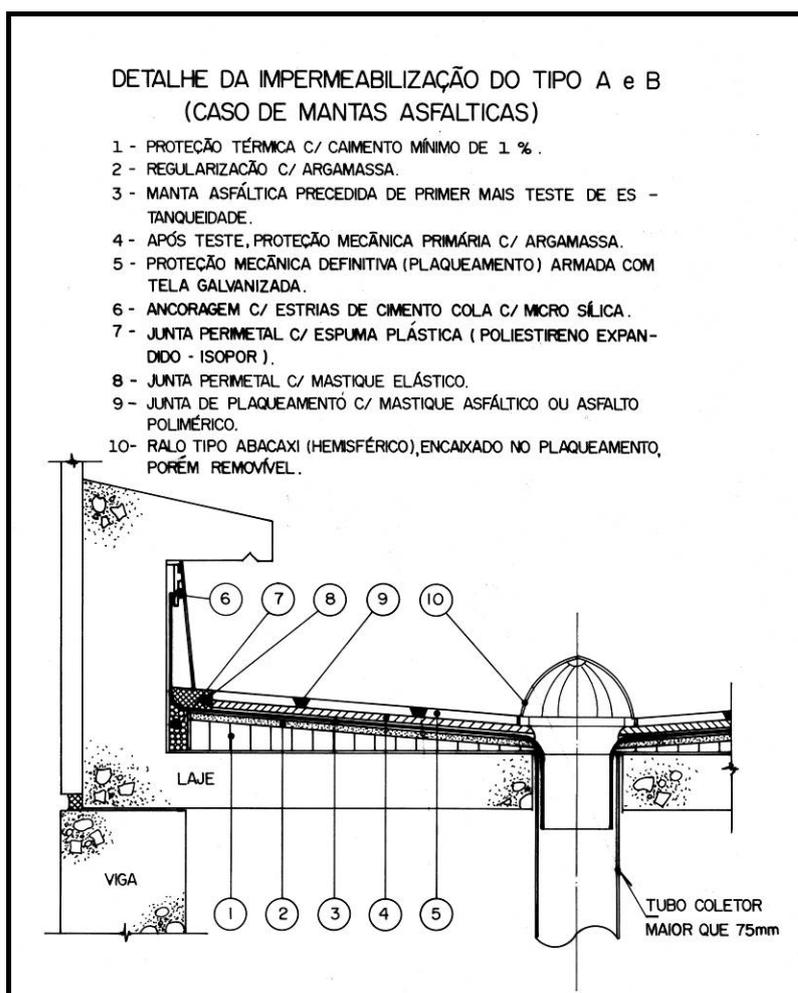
Detalhe da impermeabilização tipos A e B exemplificando o caso de utilização das mantas asfálticas estruturadas (PROMON, 1992 apud JORDY, 2002).
